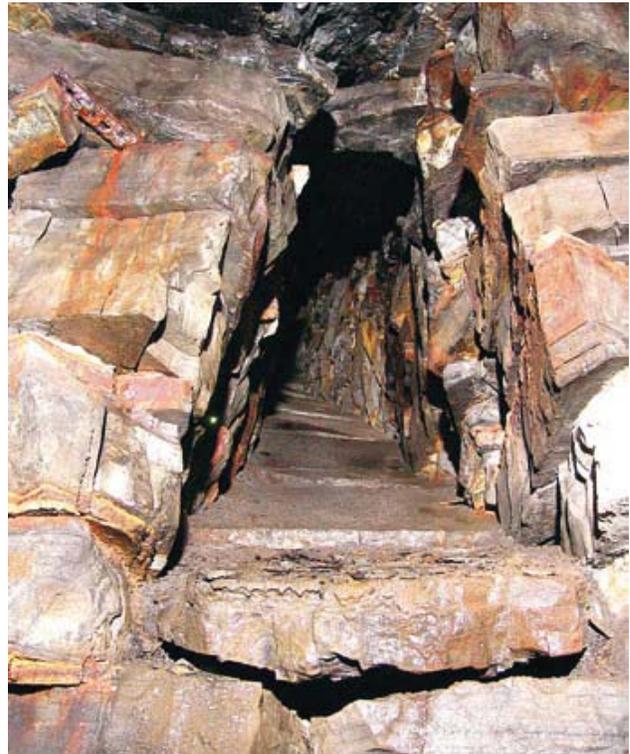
Condotto di ventilazione (foto A. Ferrario).
